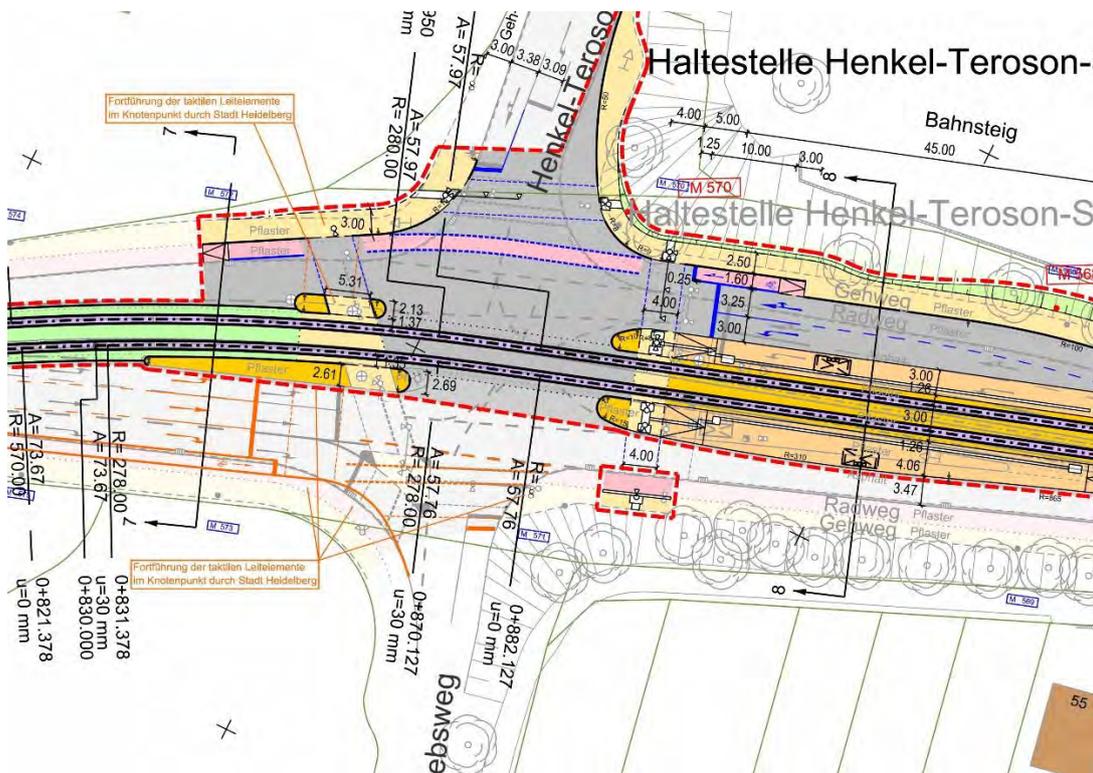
Vorabzug Lageplan Planung Henkel-Teroson-Straße<sup>15</sup>
